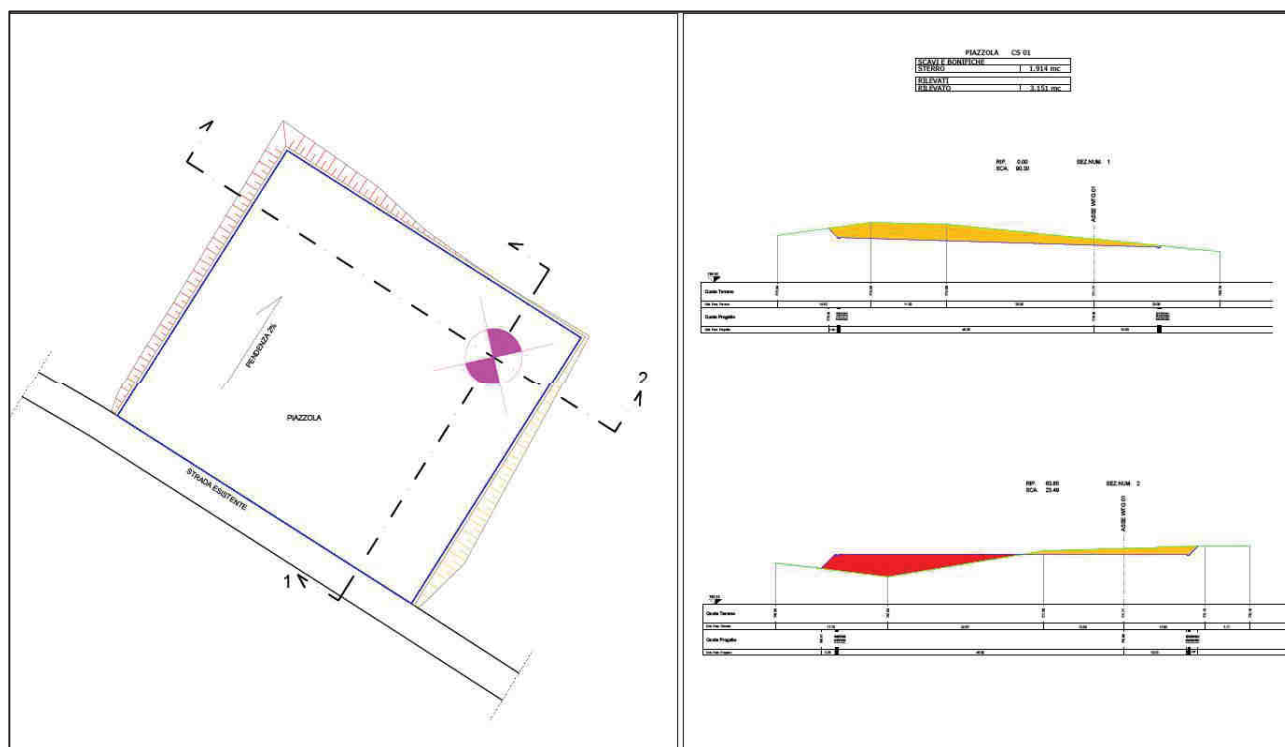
Pianta e sezioni Piazzola CS01 (fase di cantiere) con relativi scavi (arancione) e riporti (rosso).
